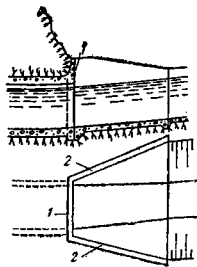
Конструкция выходного портала безнапорного туннеля
